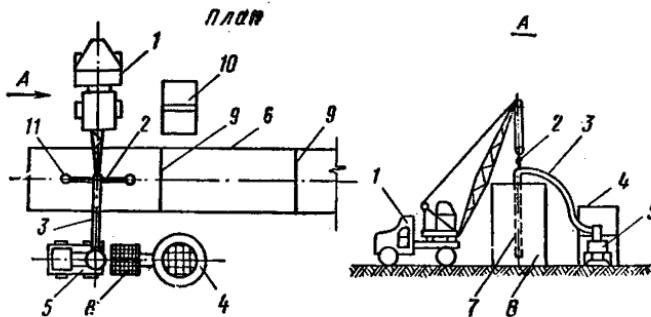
Схема размещения оборудования при бетонировании конструкций вибромагнетальным методом
